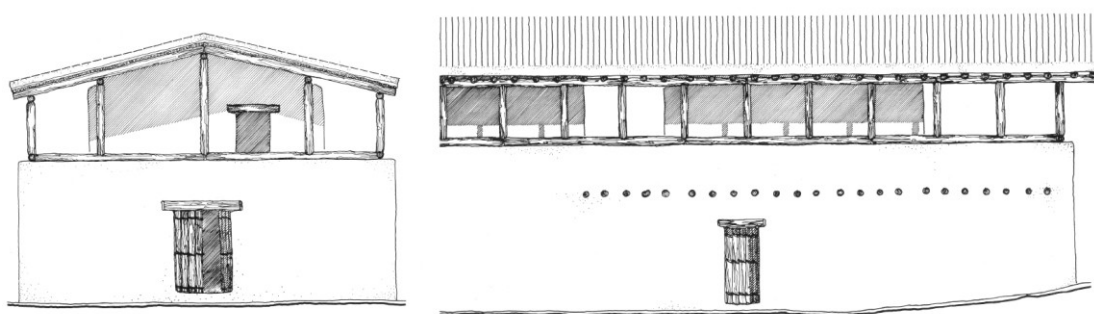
Kolonna, *Weisses Haus*. Ricostruzione assonometrica. Rielaborazione grafica E. Ballan (WALTER-FELTEN 1981, figg. 9-10).
